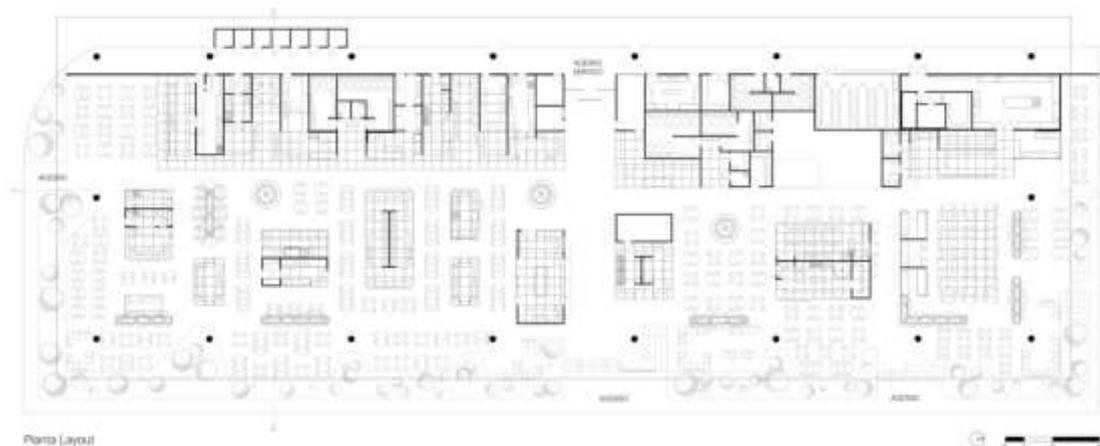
Planta Layout - Mercado Mané / Bloco Arquitetos
